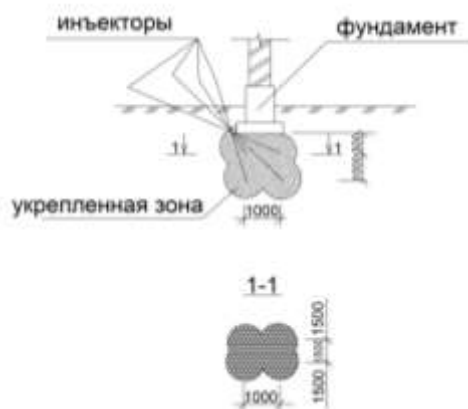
Схема цементации основания под ленточными фундаментами здания.
